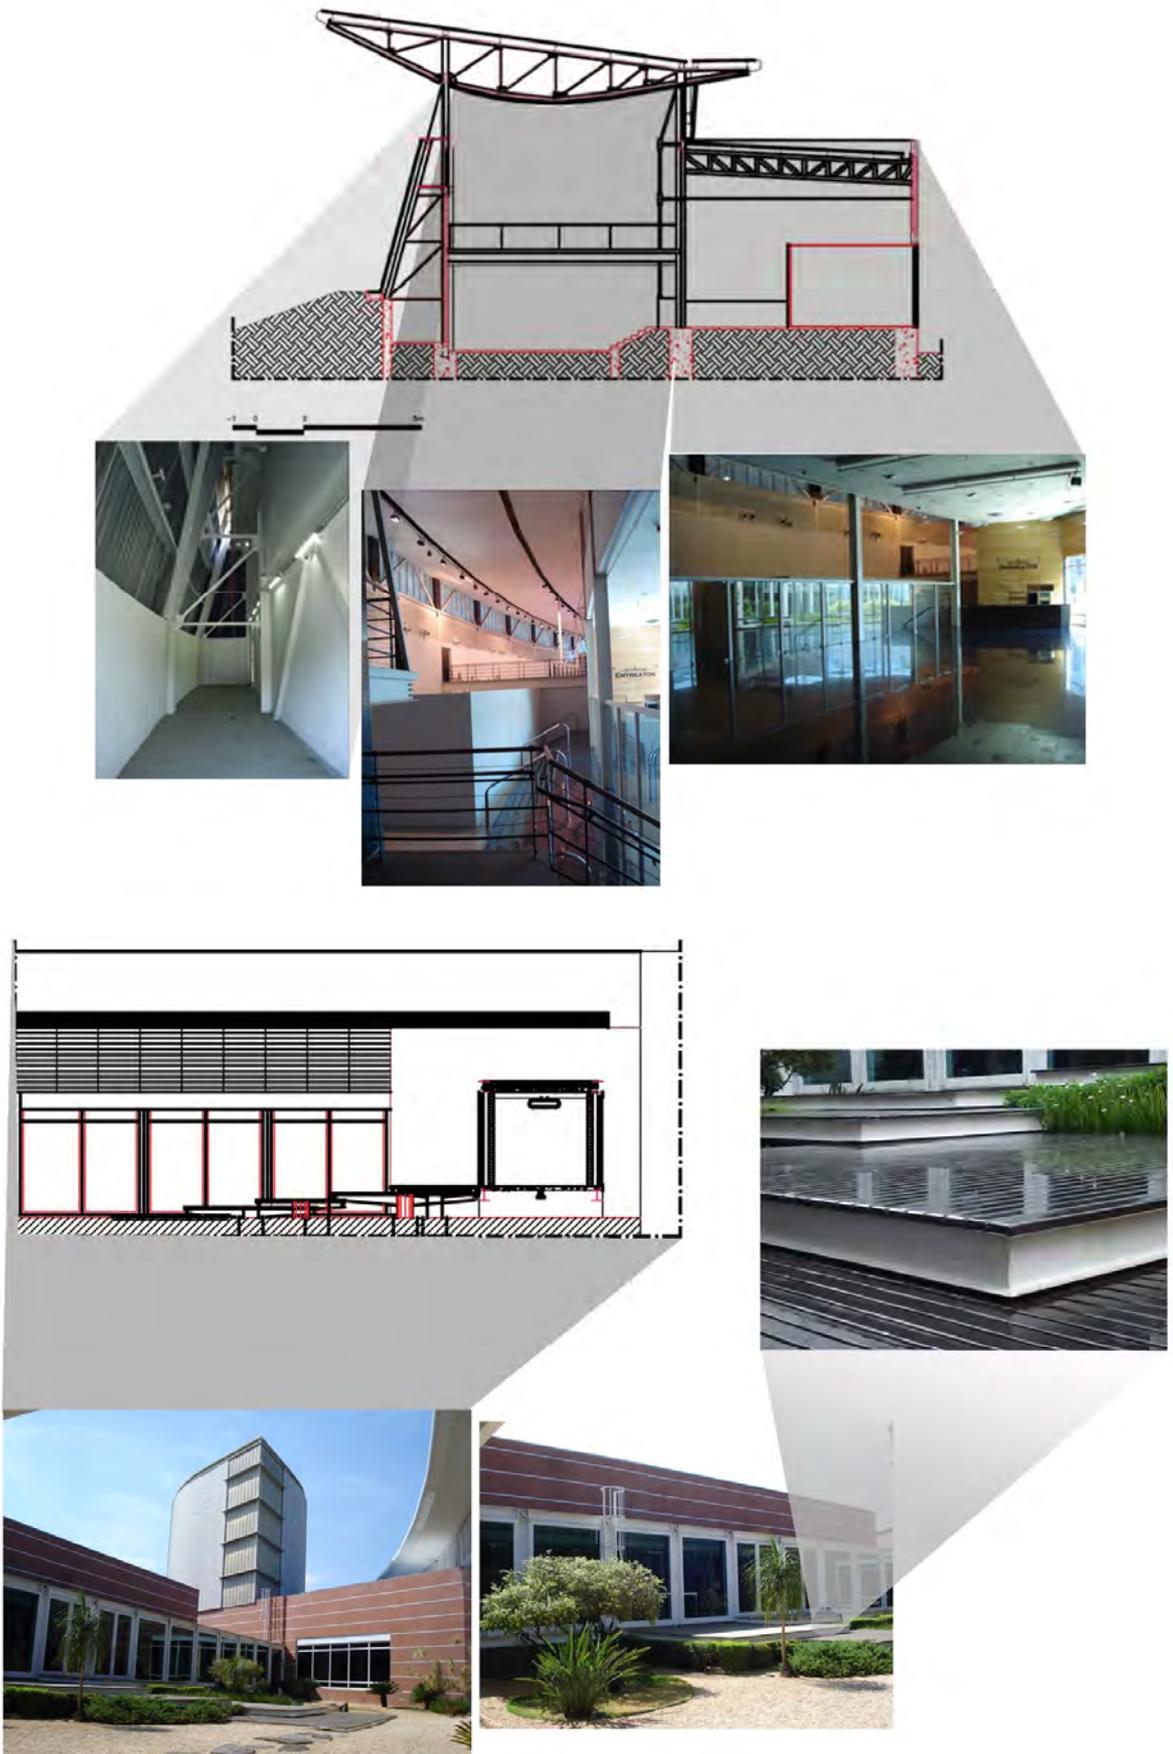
Projeto de fachada e imagens da face posterior – rodovia /Projetos de fachadas e imagens das docas de exposição e teatro.
